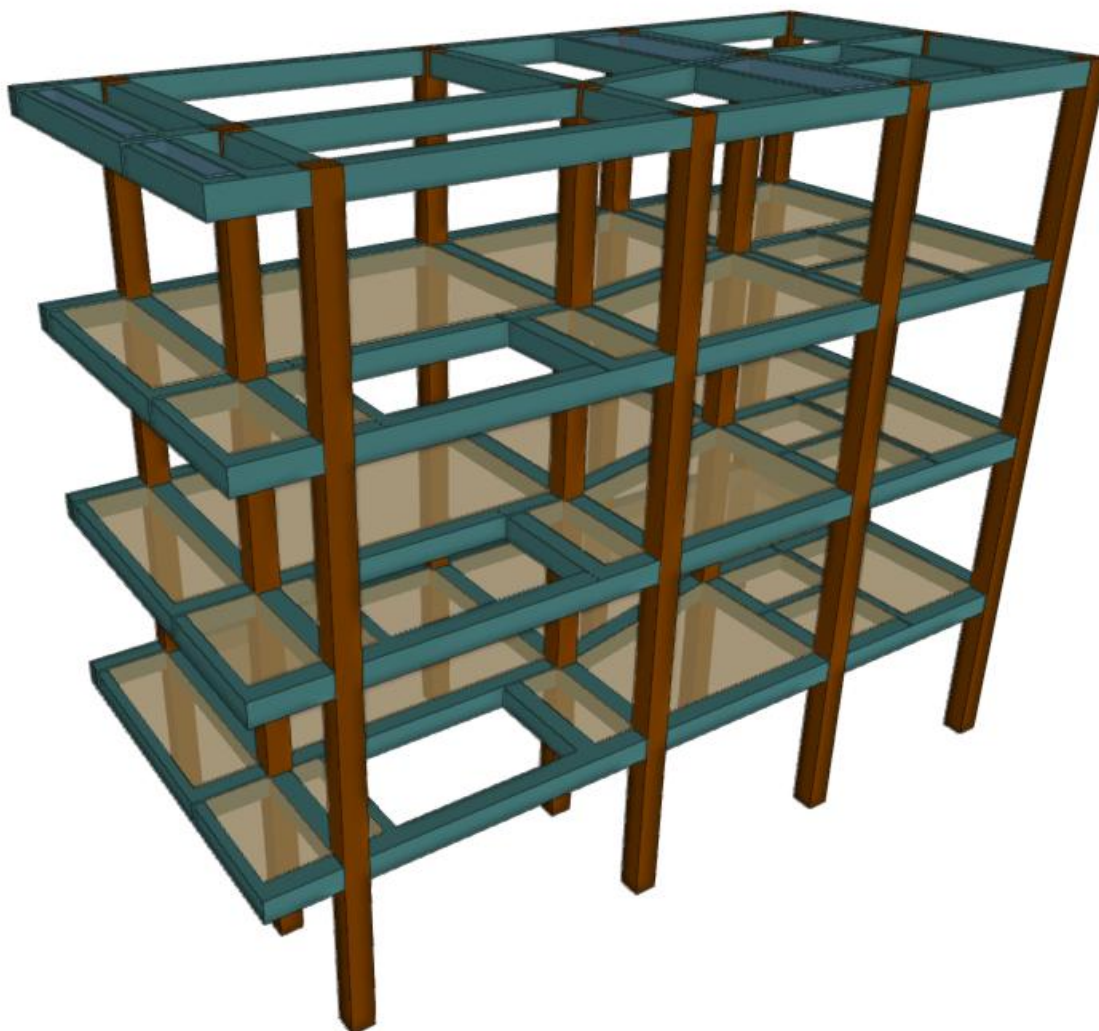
Modelo estructural con pórticos de concreto reforzado en CYPECAD.
